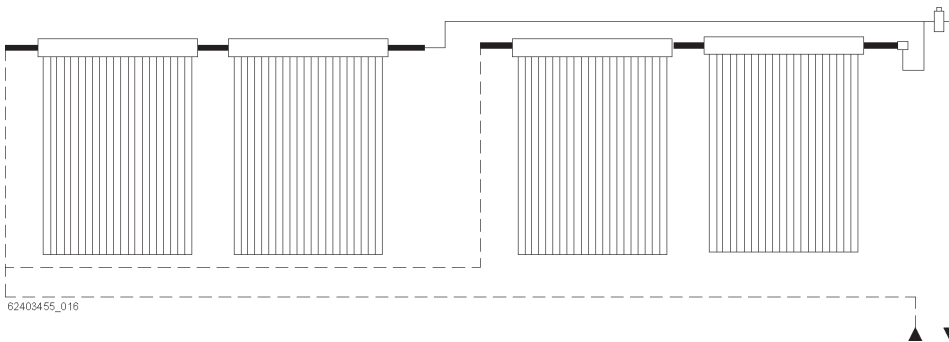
Collegamento in parallelo di pannelli HEATPIPE
